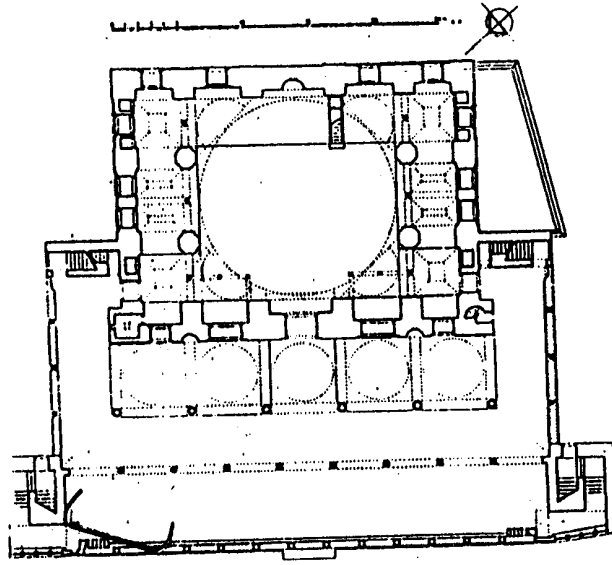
مسقط أفقي لجامع الصفا بديار بكر
